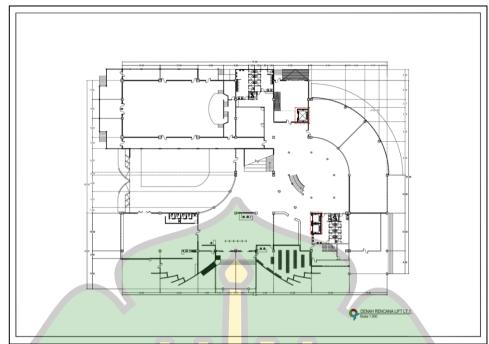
Denah Rencana Ramp Sumber: Data Pribadi
